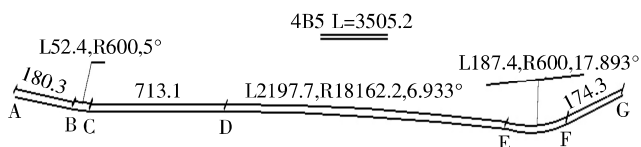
40+64+40m 连续梁边跨底板 B5 钢束平面图
